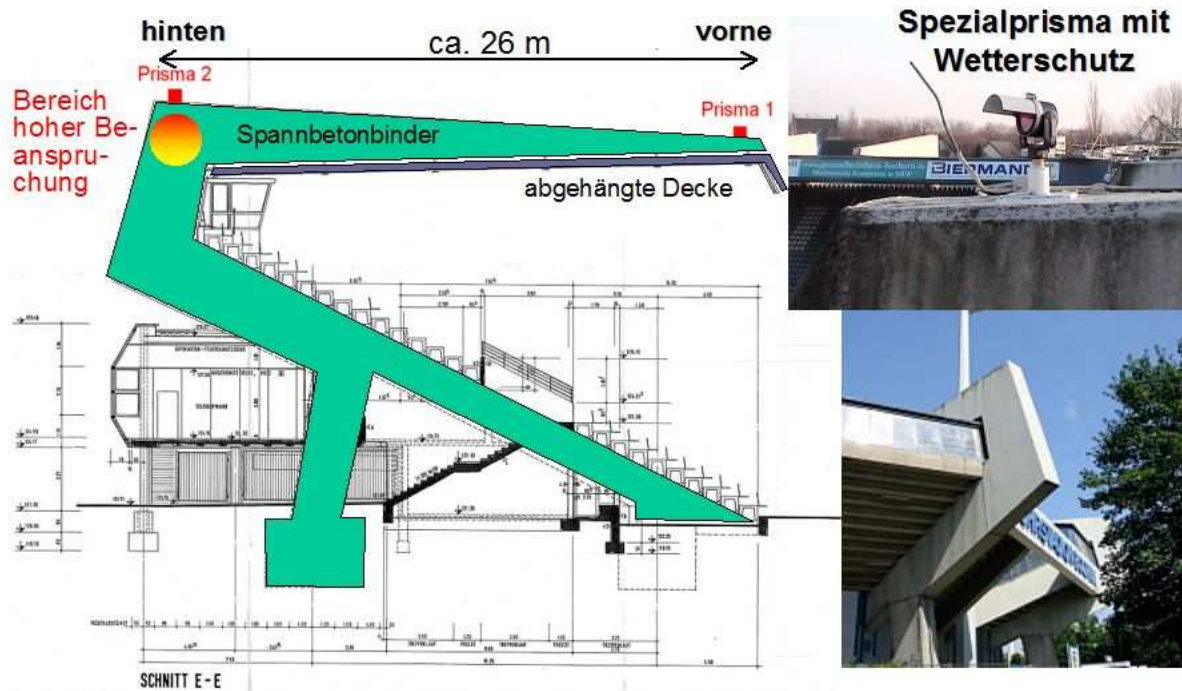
Konstruktion eines Spannbetonbinders; rechts: Foto eines Binders mit Prisma
